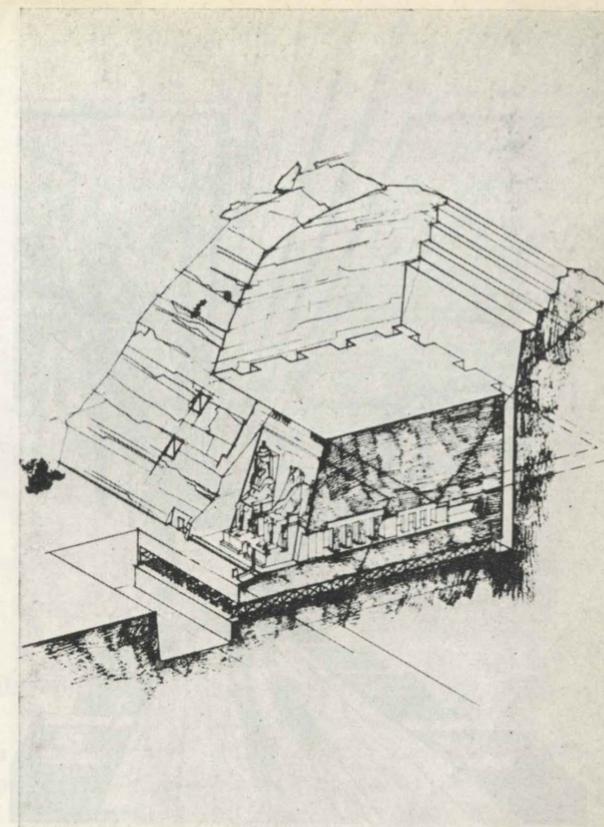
Vista assonometrica del blocco che contiene il tempio (durante l'escavazione dei pozzi verticali).
